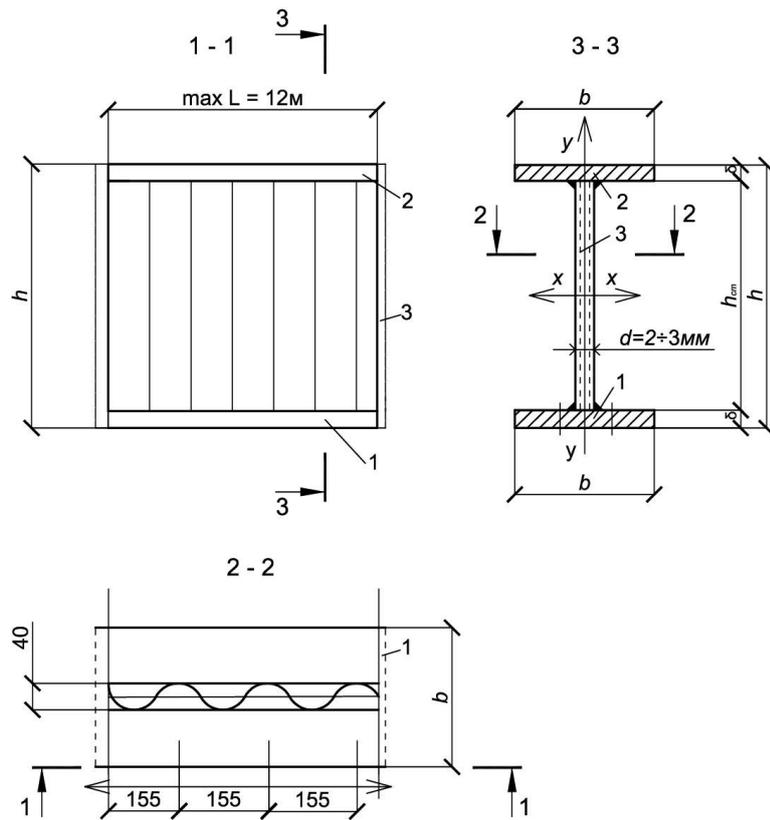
Схема составной стальной балки с гофрированной стенкой: вид сверху, продольный и поперечный разрезы
